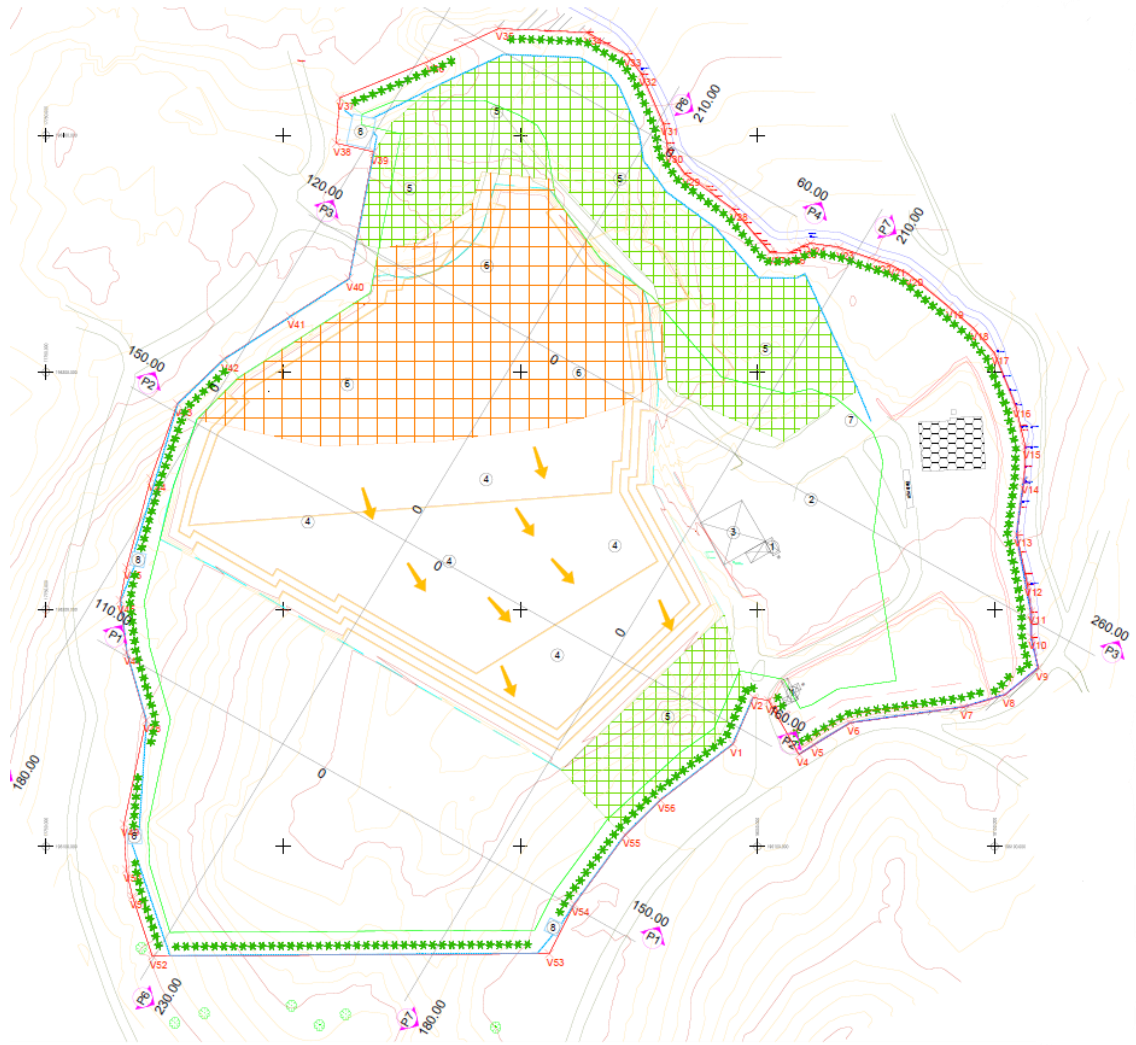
Planta de Escavação – Exploração a 20 Anos.
